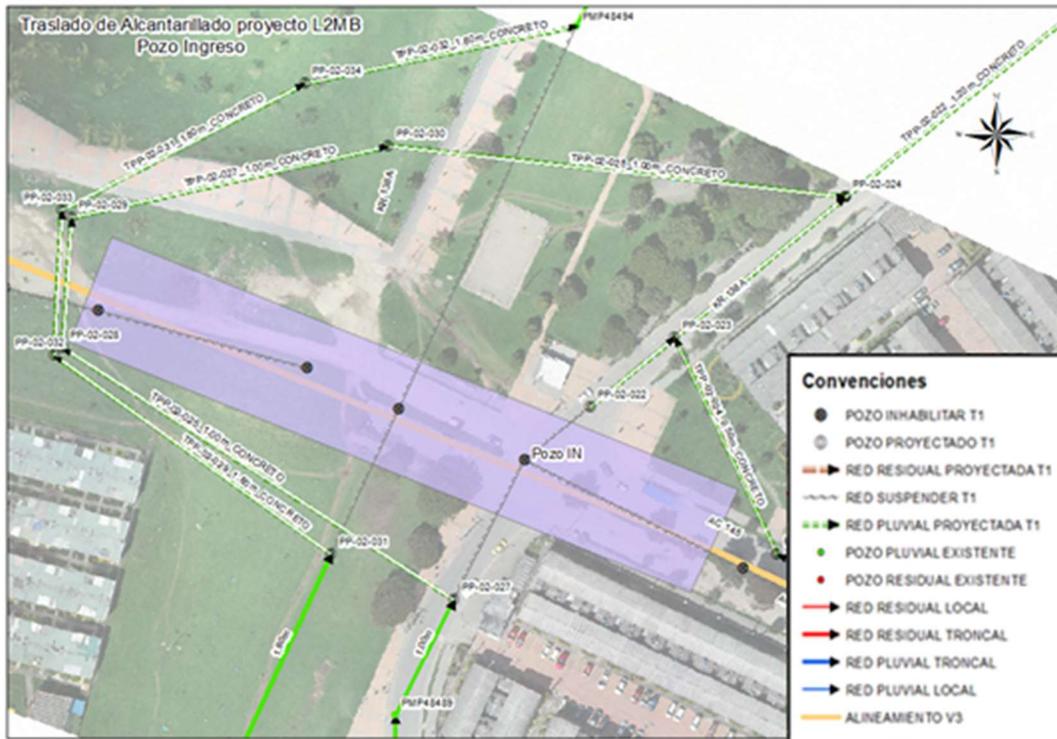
Traslado de redes de Alcantarillado Pozo de Entrada Carrera 138A con Calle 145 Red Pluvial Costado Occ
